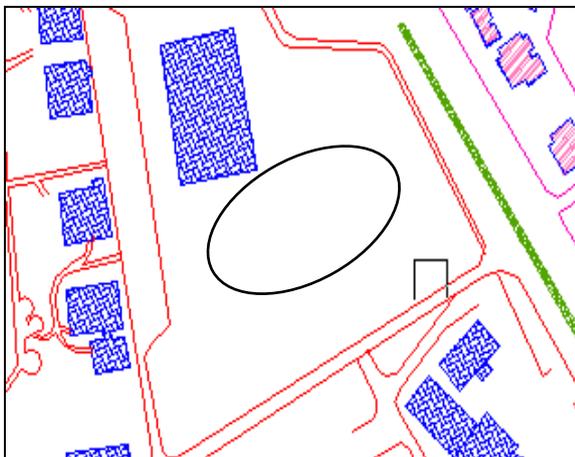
Vue en plan de la parcelle avant l'intervention
